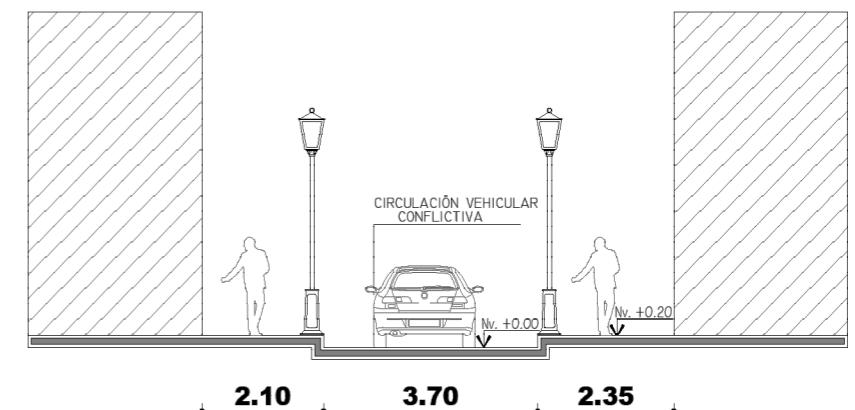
Corte estado actual de la calle Rocafuerte.
